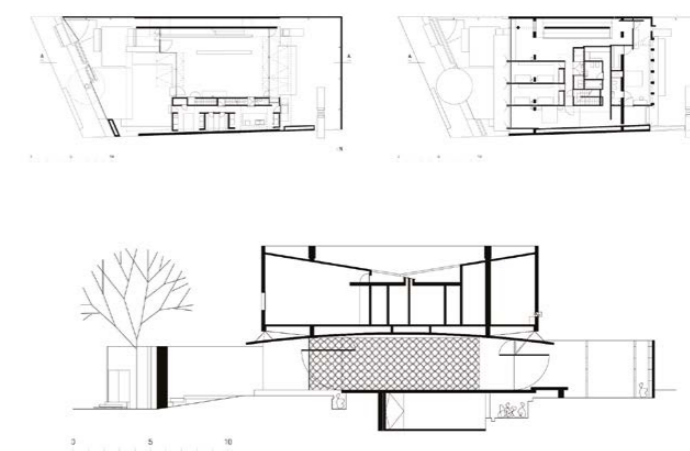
Fachada de acceso a la Casa Abu & Font (2004-06). Fuente: Enrico Cano (www.enricocano.com/solano-benitez). | Figura 4. Plantas y sección transversal de la Casa Abu & Font (2004-06). Fuente: Dibujos de la autora.
